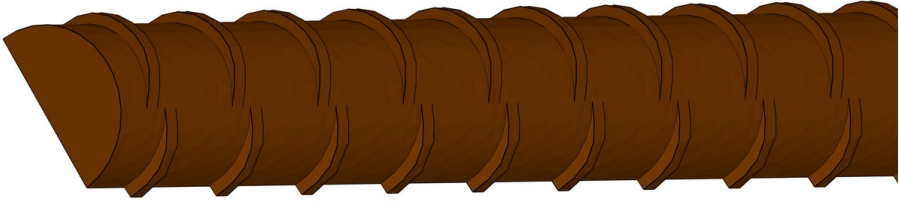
Detail: Ausbildung der Betonstahlrippen im Modell des räumlich diskretisierten Bewehrungsstabes
